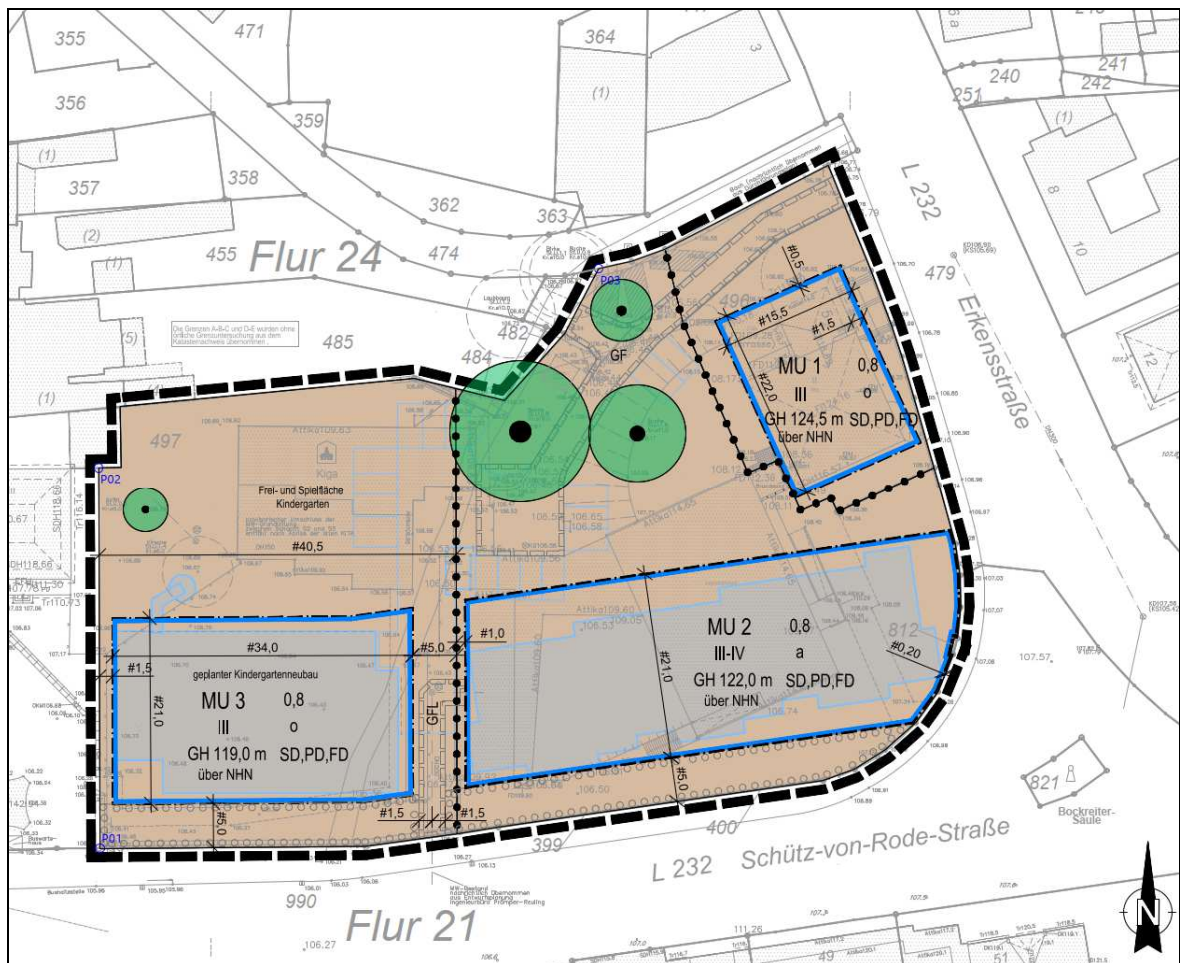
Darstellung des Entwurfs der Planzeichnung zum Bebauungsplan (Quelle: Planzeichnung zum Bebauungsplan, Planungsbüro MWM)
